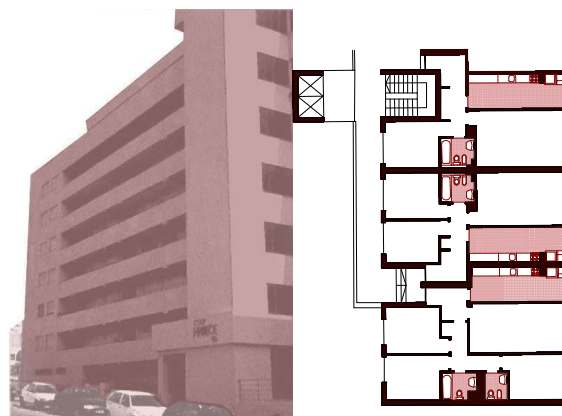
Prémio INH 1996 - fotografia e planta habitação tipo
